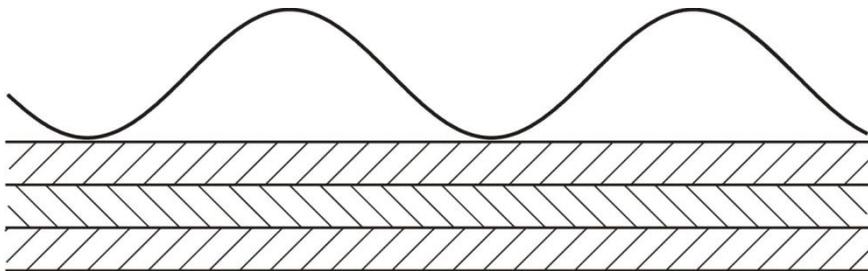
Coupe à travers une tôle profilée ondulée autoportante, fixée sur un support.
